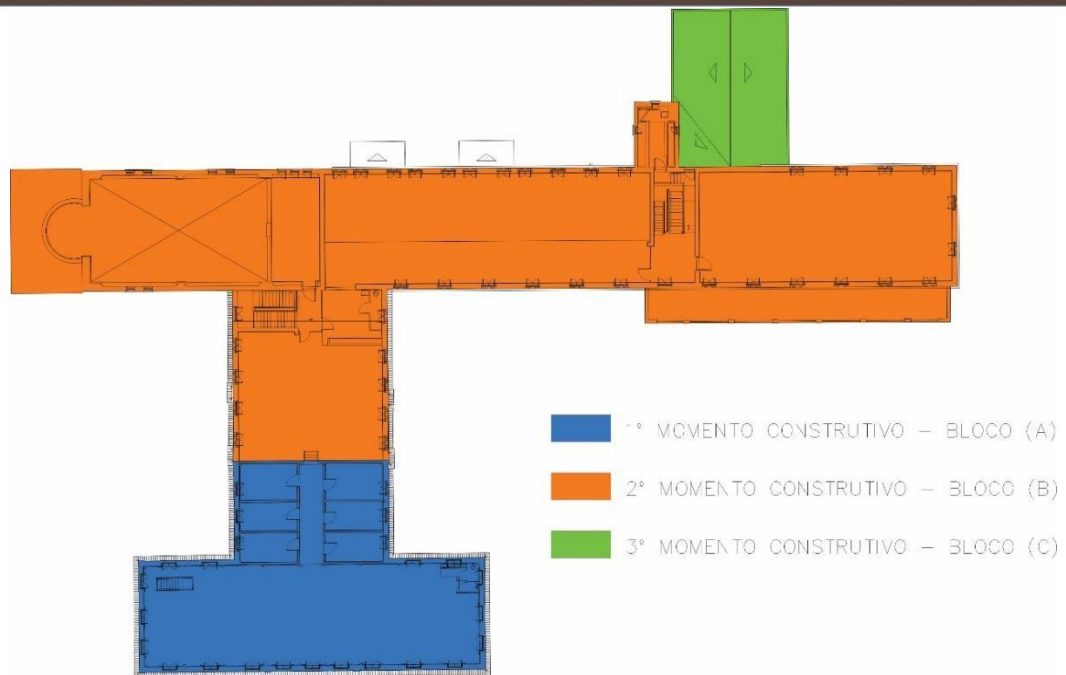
Planta Baixa 3º Pavimento – Indicação dos momentos construtivos
